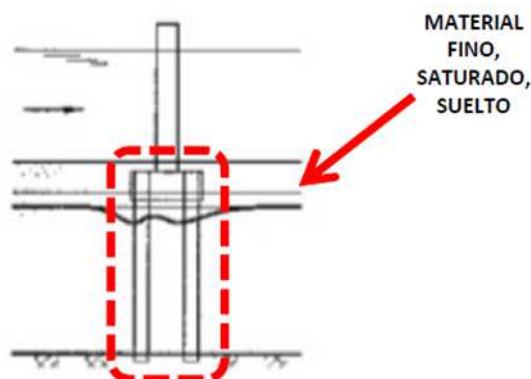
Uso de cimentación profunda. (Martin Vide, 2003)
